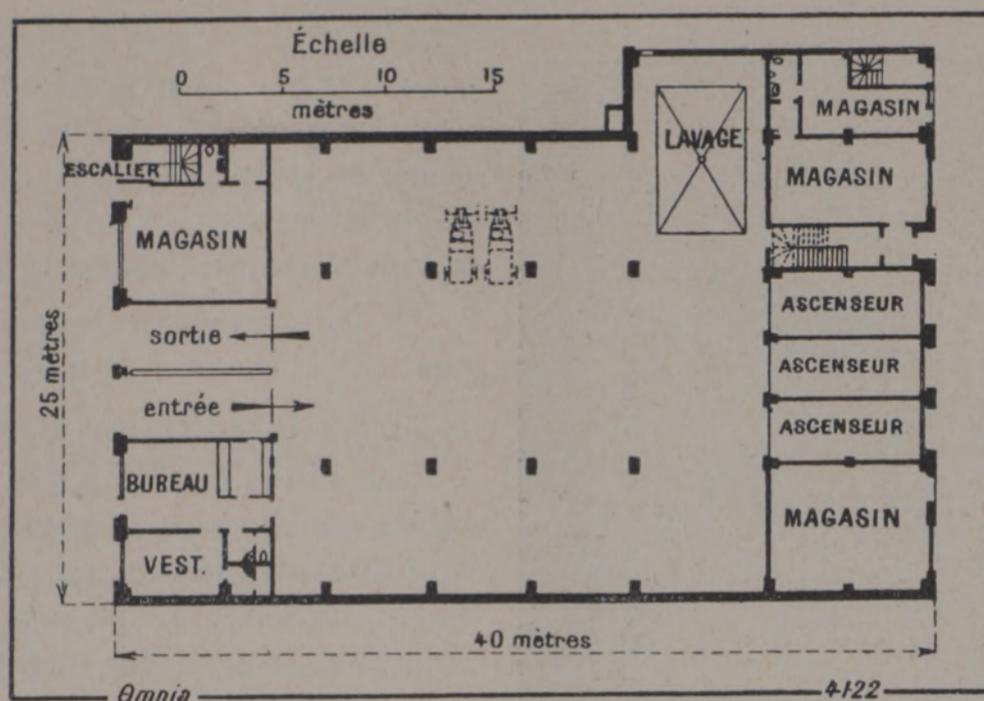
Fig. III. — Plan d'un garage à ascenseurs (Portland Street Garage, à Boston). — Le garage peut contenir 444 voitures. Il comporte 5 étages. Trois ascenseurs placés côte à côte montent les voitures aux différents étages. Le plan ci-dessus est le plan du rez-de-chaussée. (Voir la façade fig. II.)
